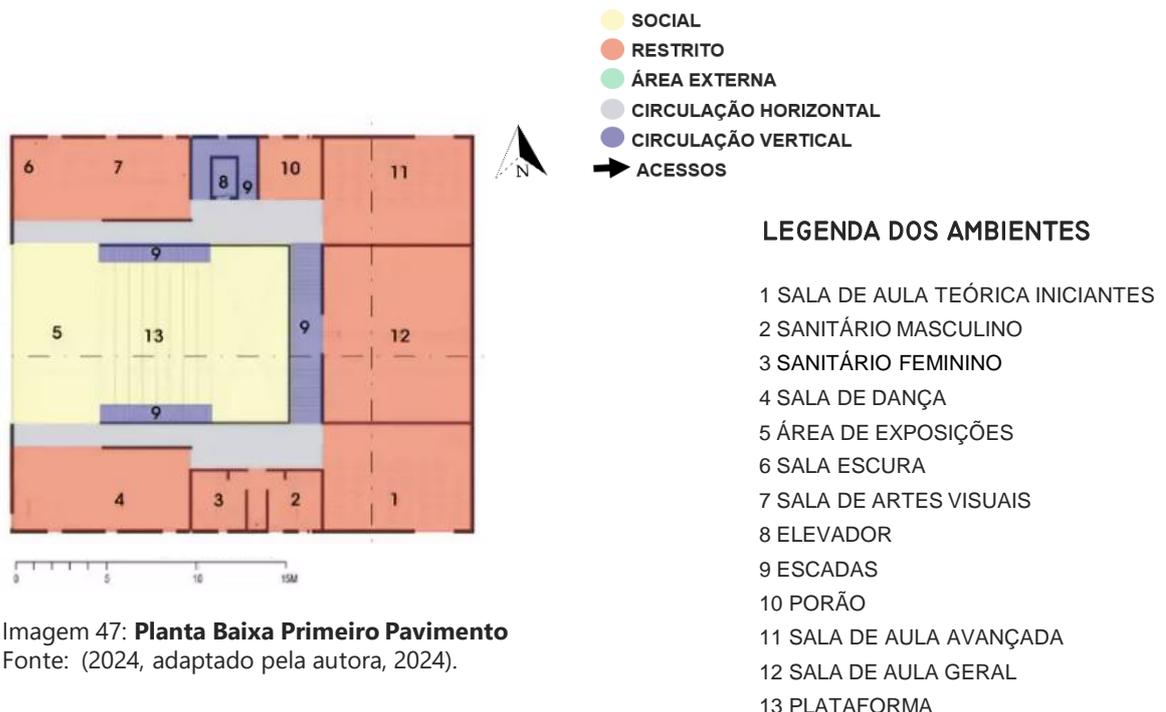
Planta Baixa Primeiro Pavimento
